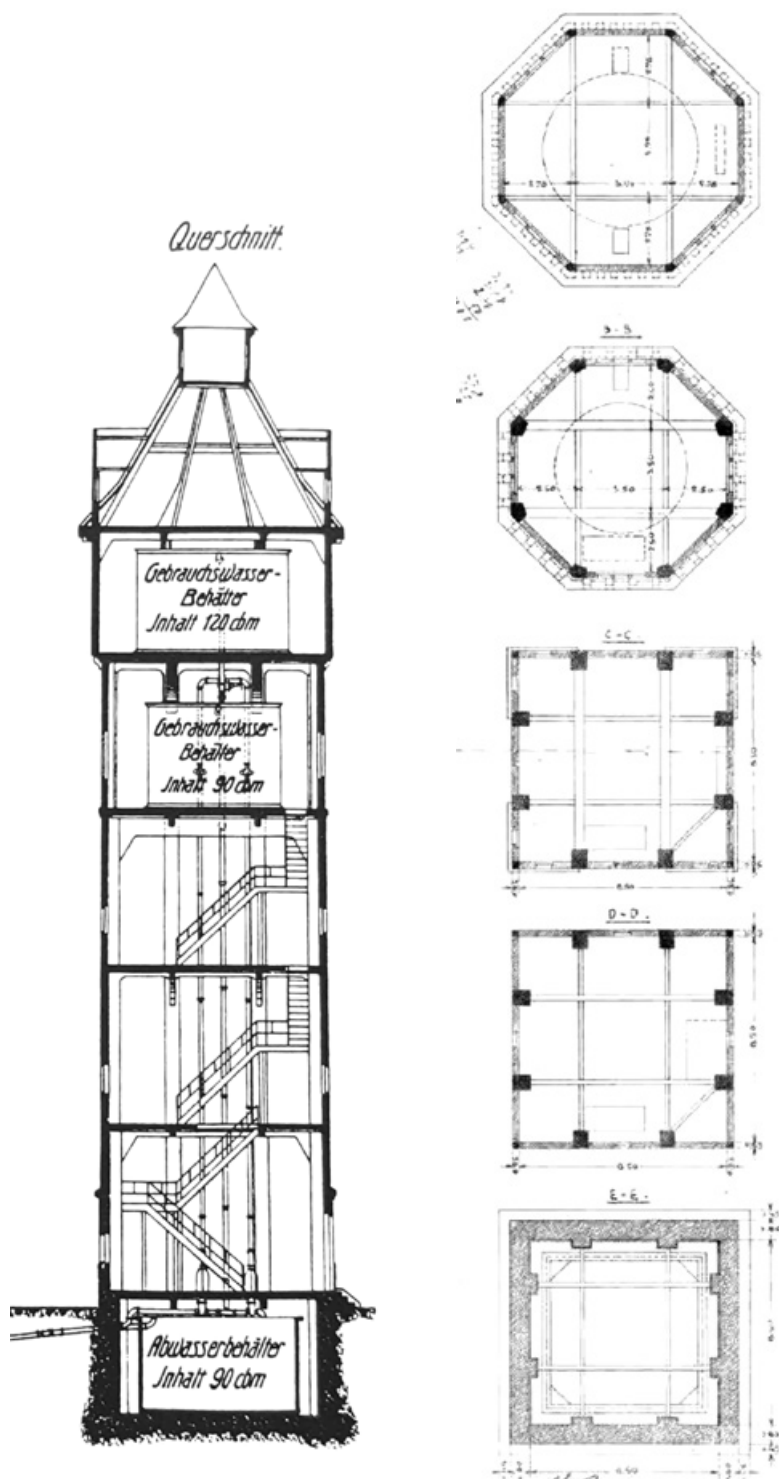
Schnitt und Grundrisse durch den Wasserturm ohne Maßstab (BAI 1978).
